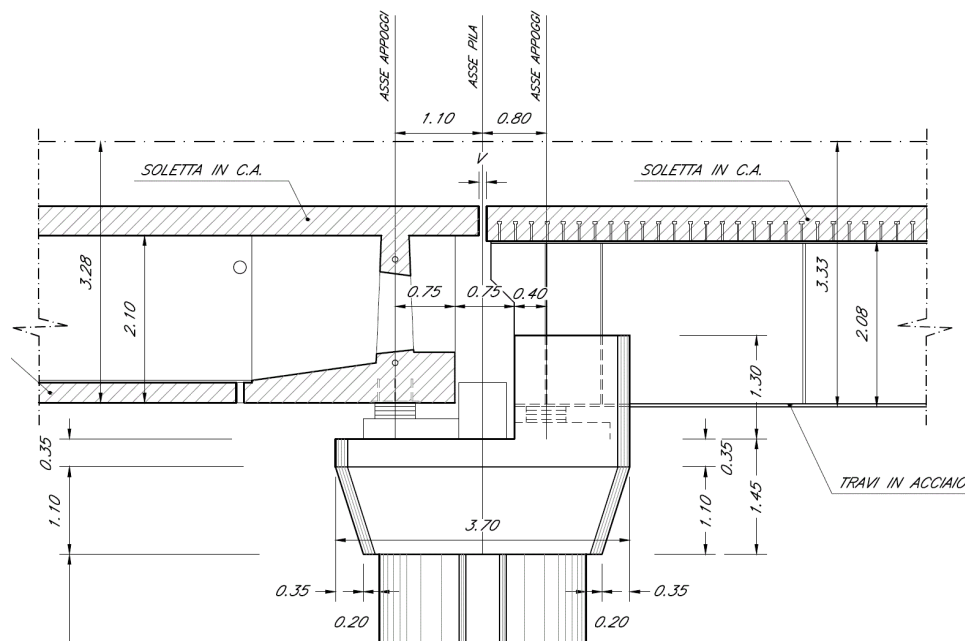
Pila, prospetto longitudinale – Impalcato CAP e impalcato a struttura mista [m]
